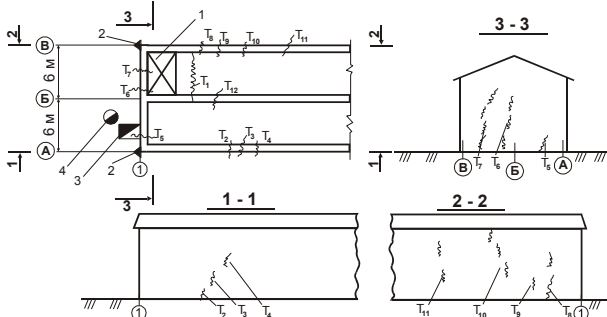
Повреждения 3-этажного кирпичного здания школы № 93 в г. Караганде: а — фрагмент плана здания; б, в, г — повреждения наружных стен; 1 — туалет; 2 — стенные марки; 3 — шурф; 4 — скважина
